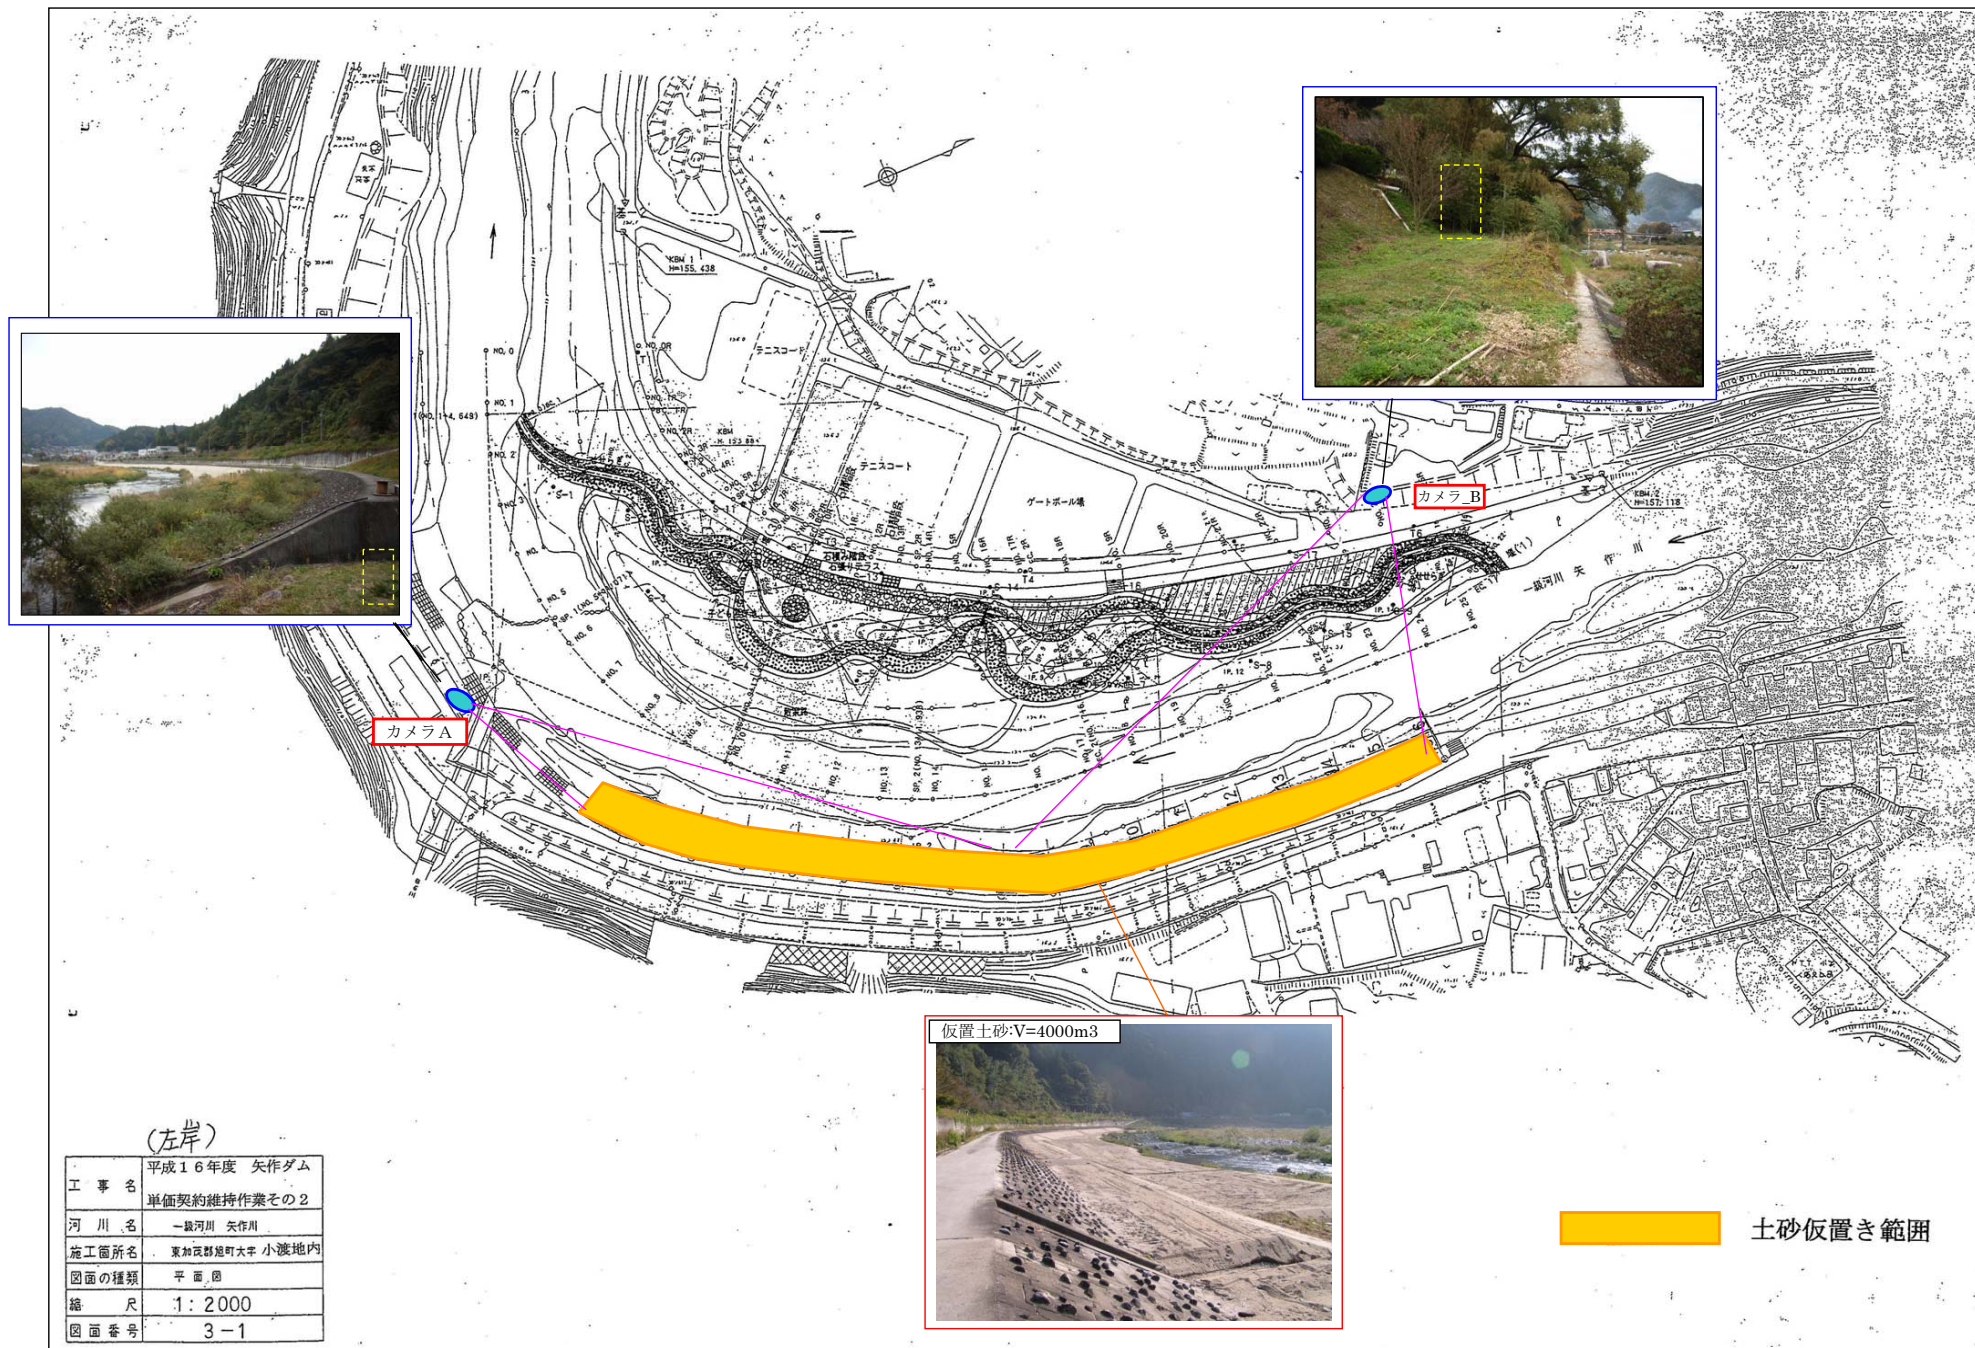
(1) 小渡地区観察カメラ設置計画平面図
